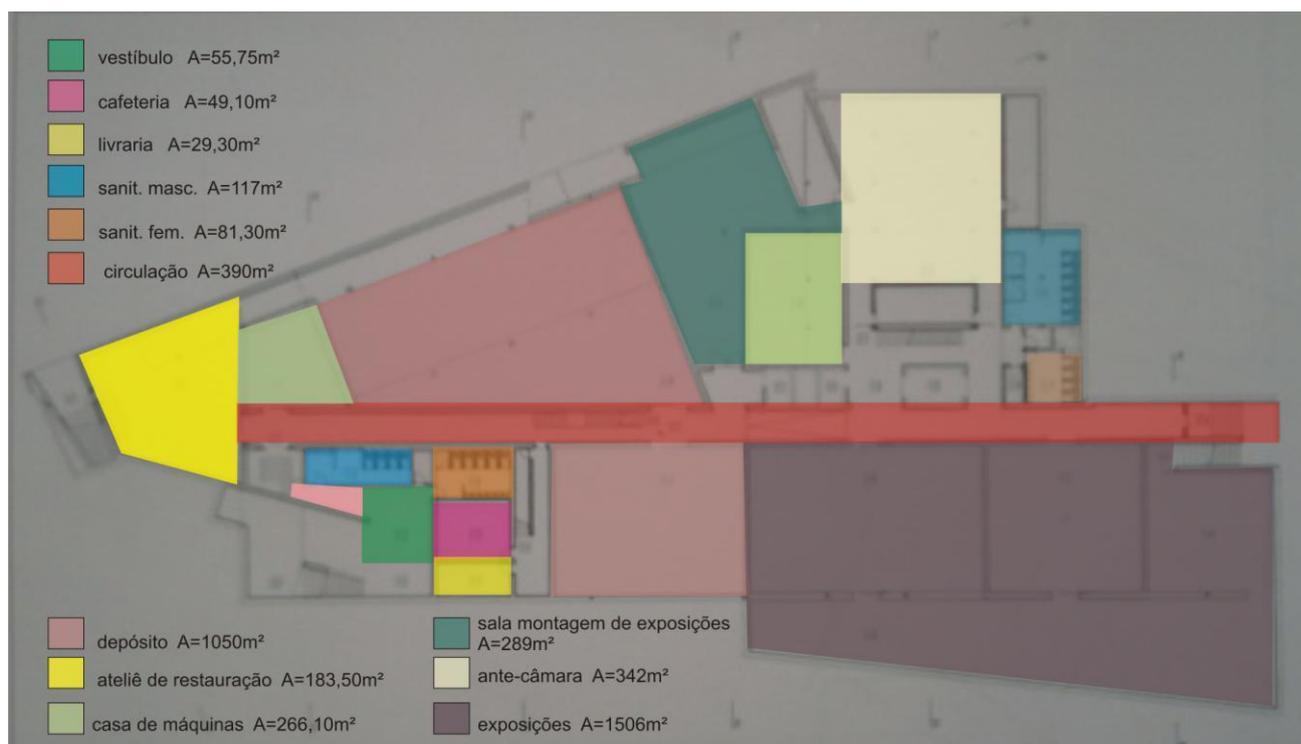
Planta Baixa 2º Pavimento (TRIGUEIROS, 1995).
